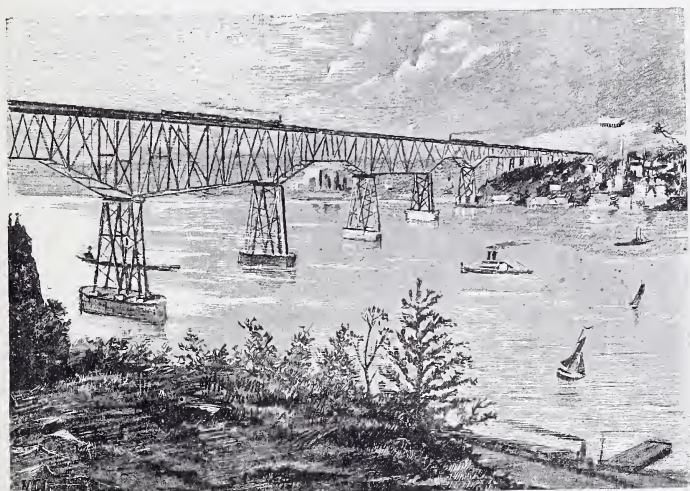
Pont de Poughkeepsie. — Vue d'ensemble.
